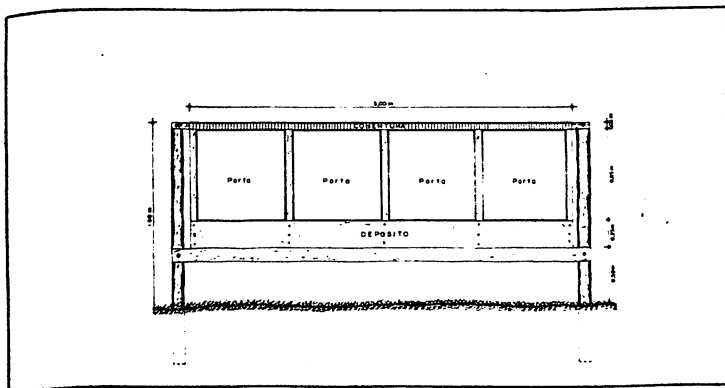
Vista frontal de um mini-saleiro automático modulado com 4 unidades.
